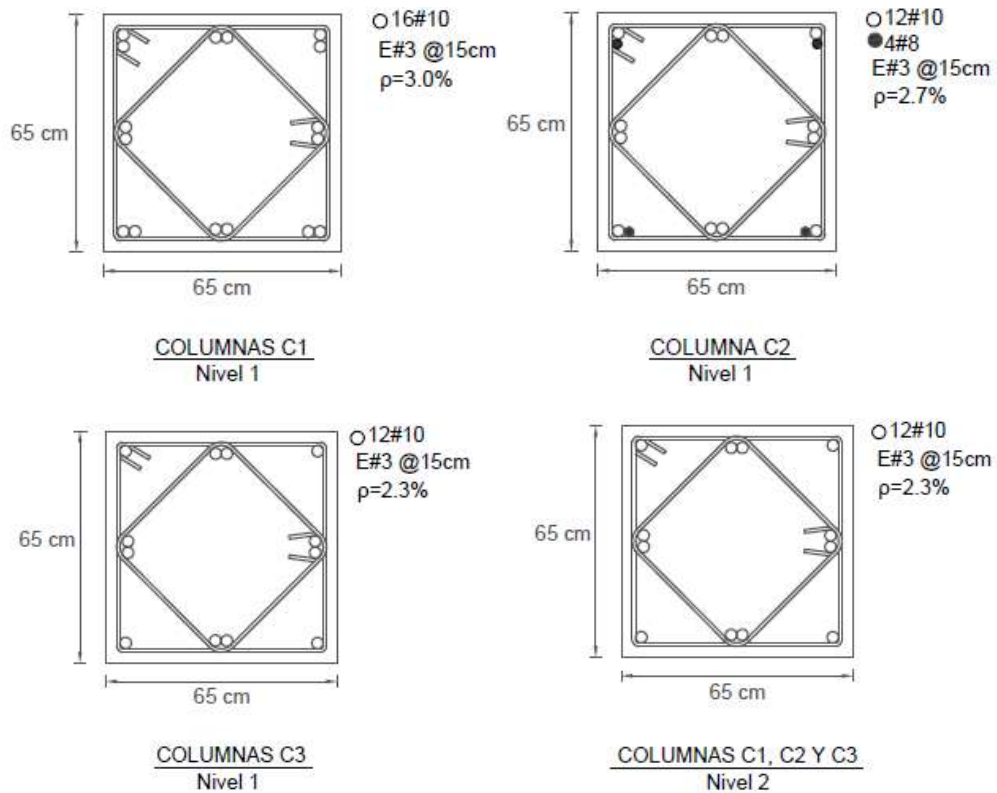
Armado de vigas y columnas del edificio de 8 niveles diseñado con las NTCS-76 con un Q igual a 4
